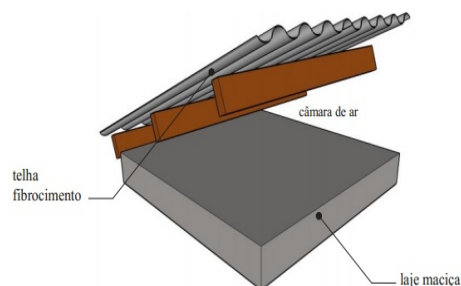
Croqui do Sistema construtivo da cobertura. Fonte: Imagem adaptada Inmetro (2013).
